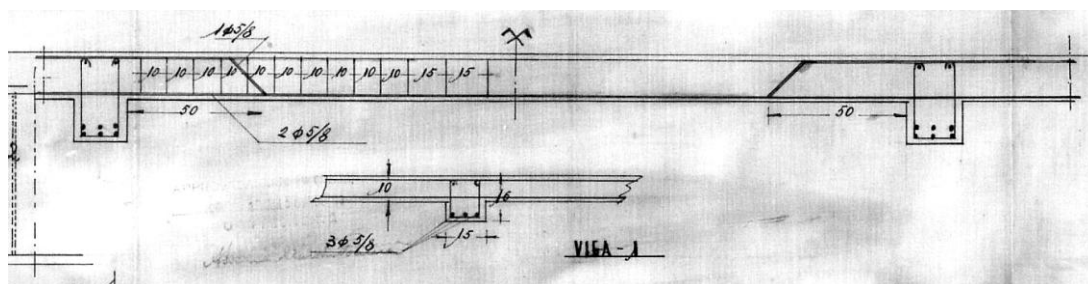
Pormenor construtivo das armaduras nas lajes e vigas do pavimento do piso 1 [6]
